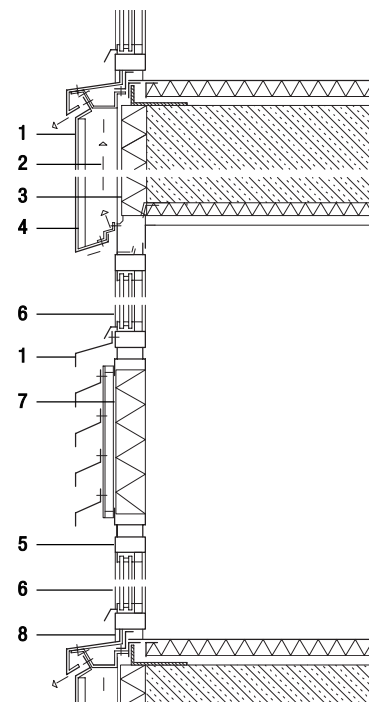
Vertikalschnitt durch die Fassade, Maßstab 1 : 20
